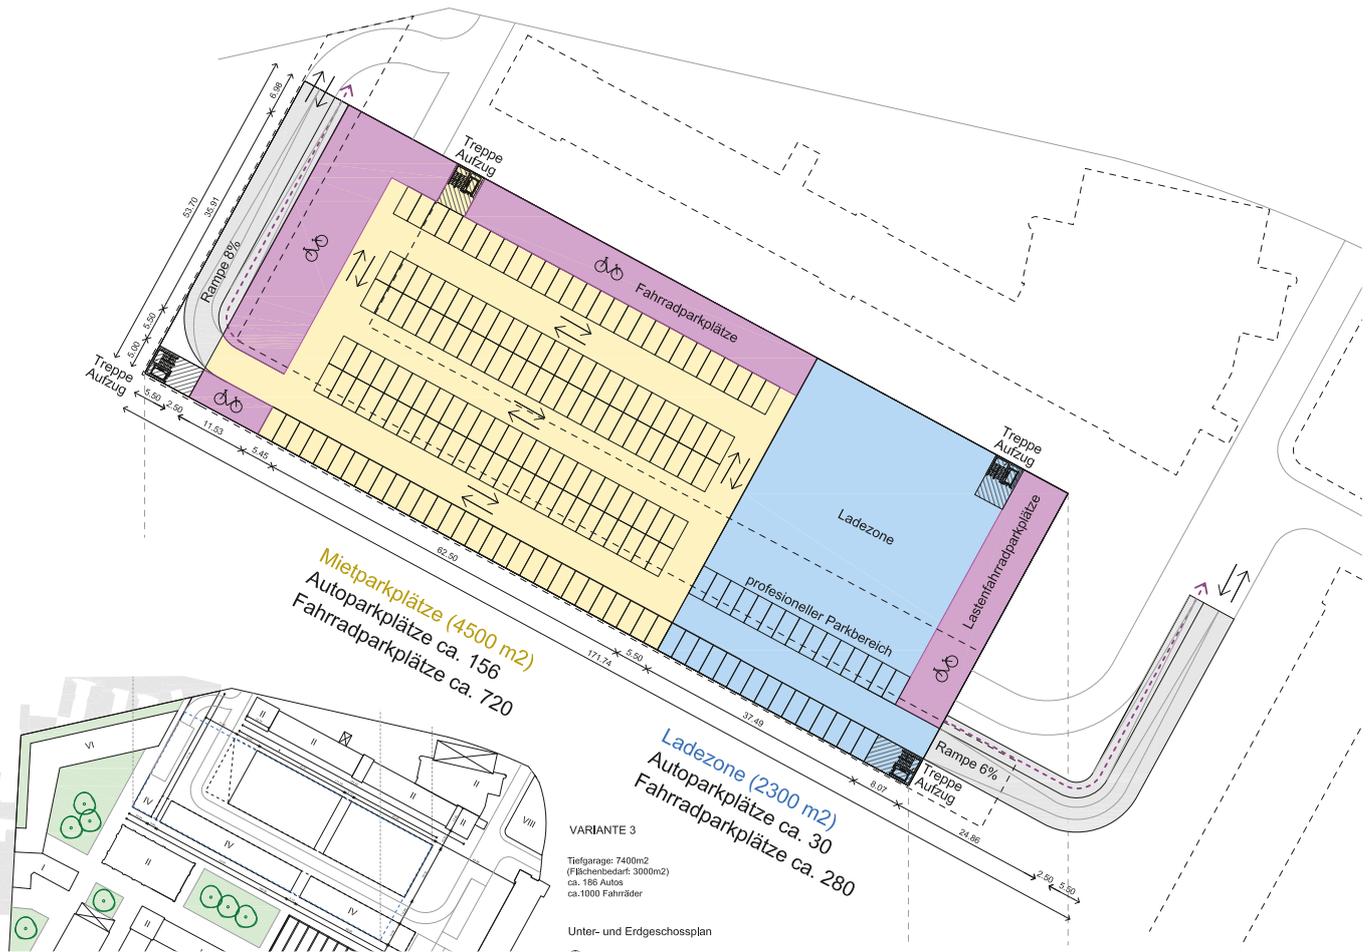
Flächennachweis einer möglichen Tiefgarage mit Ladezone
